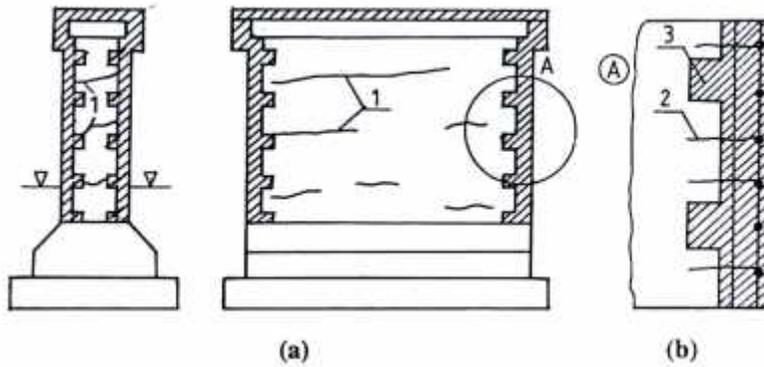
Reinforced Concrete Jacketing). Penambahan penampang setempat
